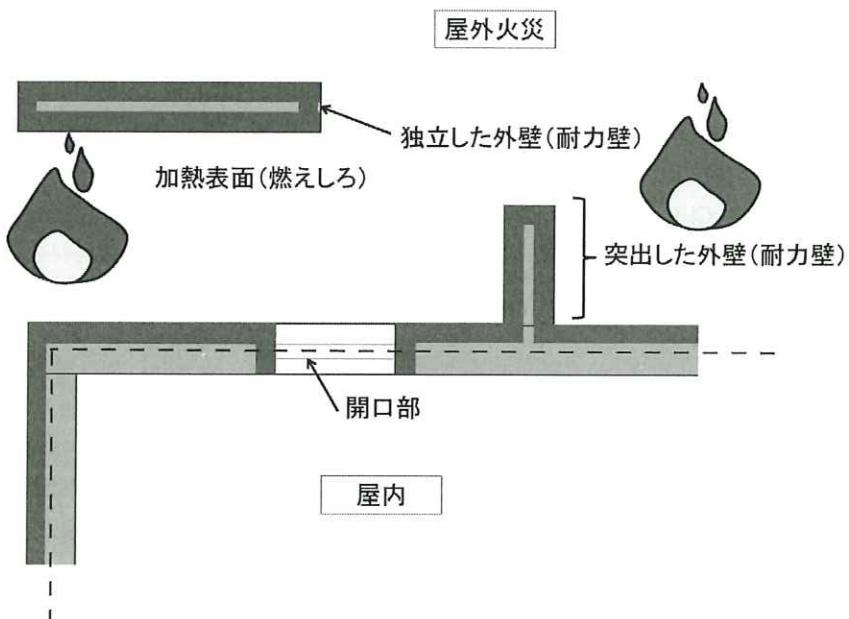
屋外火災における防火区画内の燃えしろ想定面（平面図）
